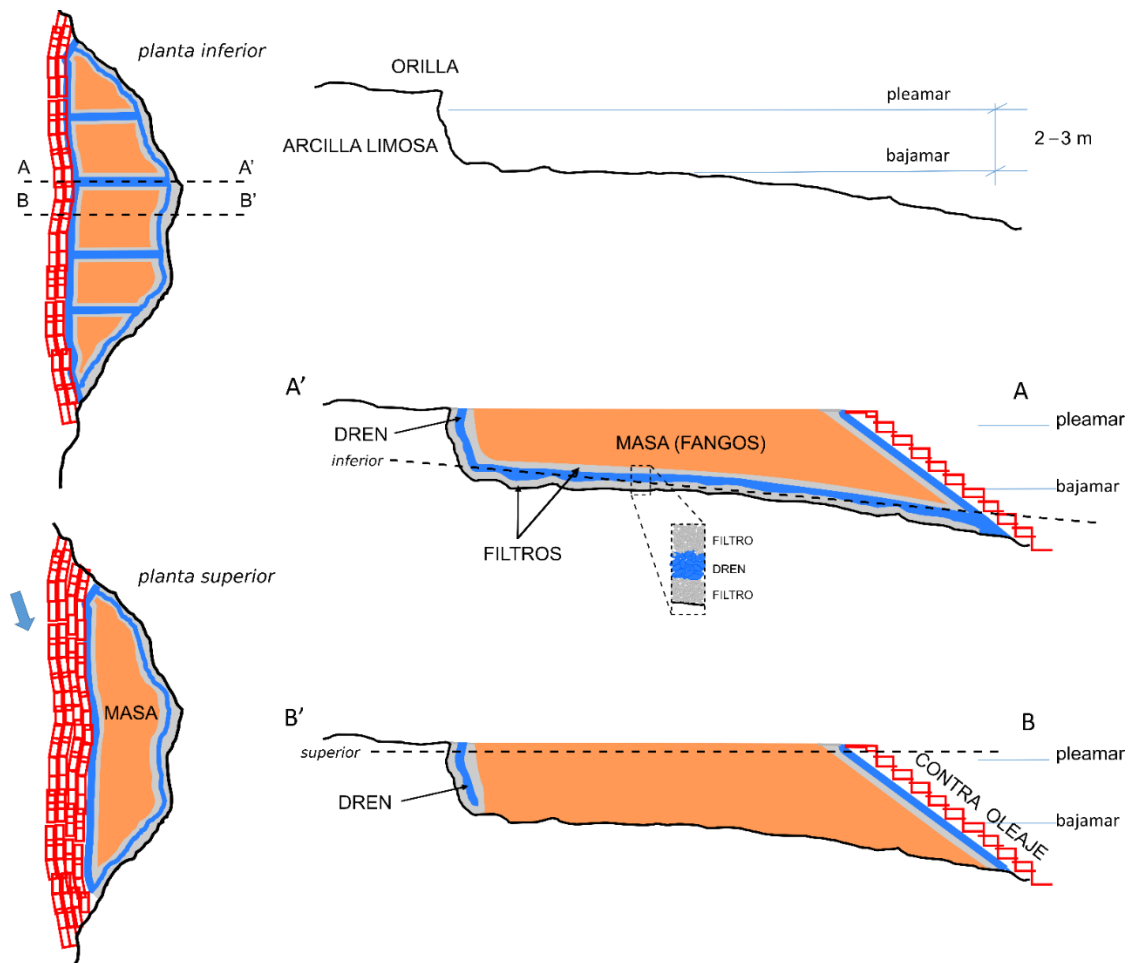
Esquema en planta (izquierda, flujo de arriba a abajo) y en secciones tipo (derecha) de la protección de orilla en zonas de erosión patológica; secciones a una misma escala horizontal y vertical dada por la dimensión de la carrera de marea; plantas dibujadas a una escala diferente, deducible de magnitudes compartidas con las secciones. Las dos plantas corresponden a los cortes superior e inferior indicados en las secciones. La sección transversal de arriba es la orilla original, las otras dos secciones transversales por AA' y BB' indicadas en planta. Se dibuja contra el oleaje un objeto escalonado, pero sería mejor la agrupación de elementos irregulares, tal vez ladrillos, o mejor, piezas con más facilidad de imbricación, hechas con los fangos de los vaciaderos en busca de una economía circular. Significado de los colores: rojo: defensa contra oleaje, azul: dren, gris: filtro, marrón: masa aportada, sin color: terreno existente. Fuente: MV. Elaboración propia, 2022.
